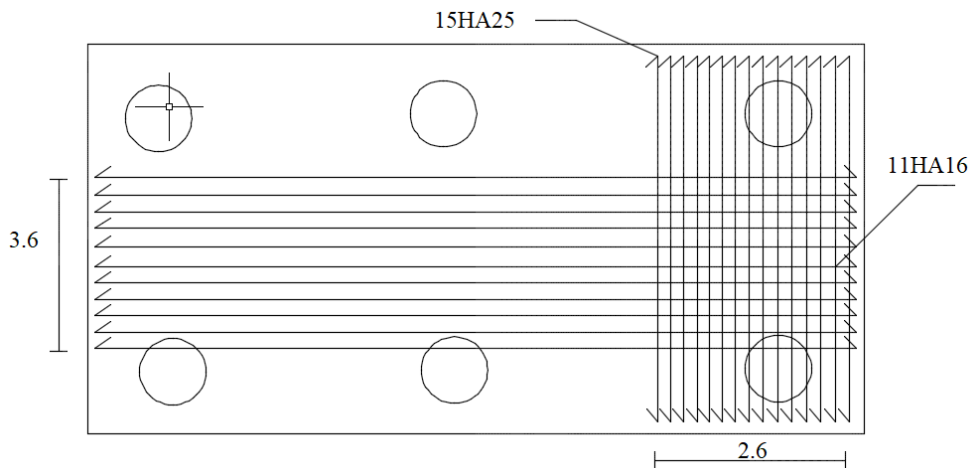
Ferrailage de la semelle en plan (nappe inférieure)
